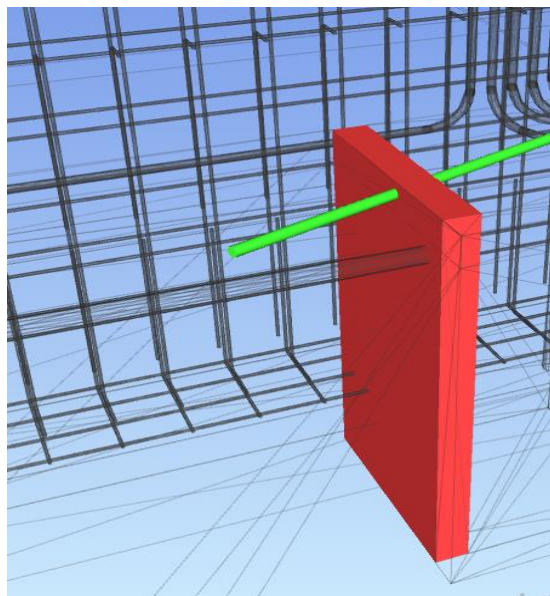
Tubería de pozo a tierra con muro de cámara de rebombeo.
